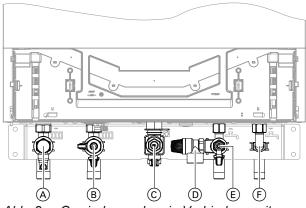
Gewindeangaben in Verbindung mit Anschlusszubehör
